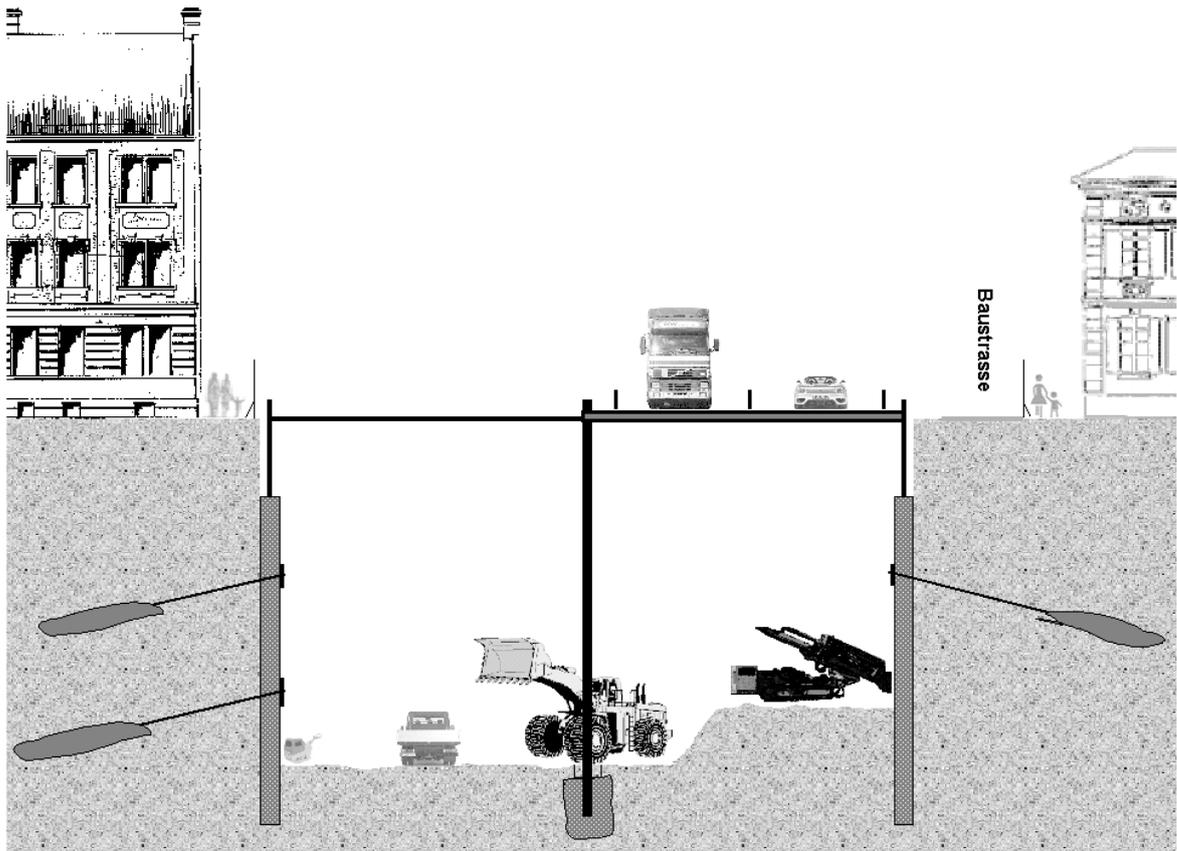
Aushub der Baugrube über die volle Breite in Längsrichtung sowie Installation der Baugrubenaussteifungen
